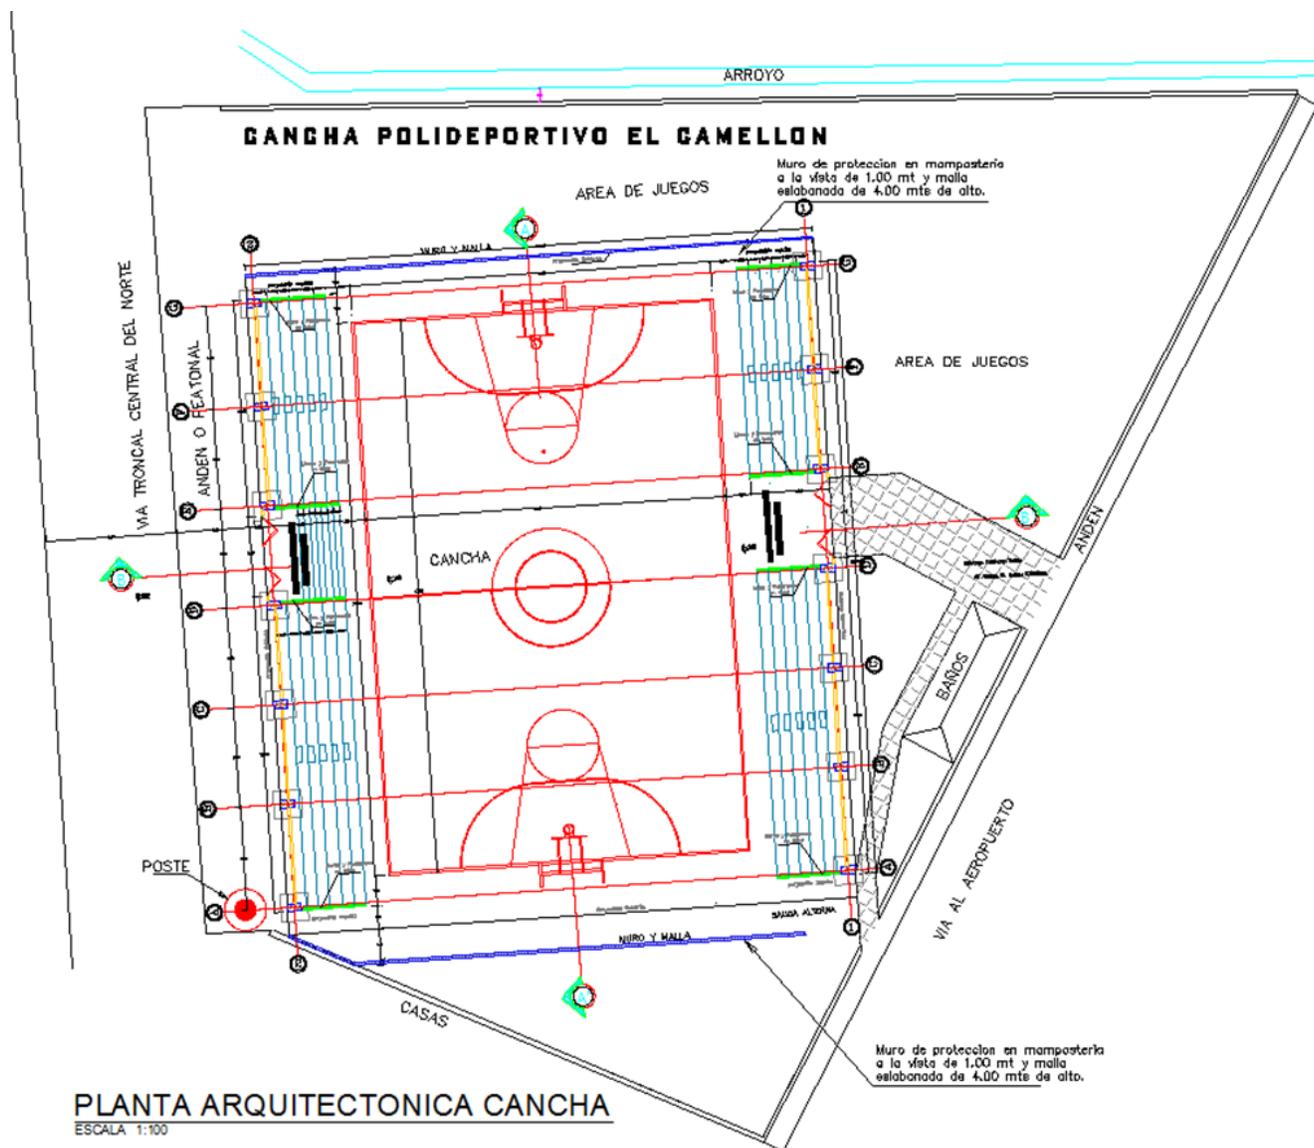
planta arquitectónica de la cancha, fuente secop I
